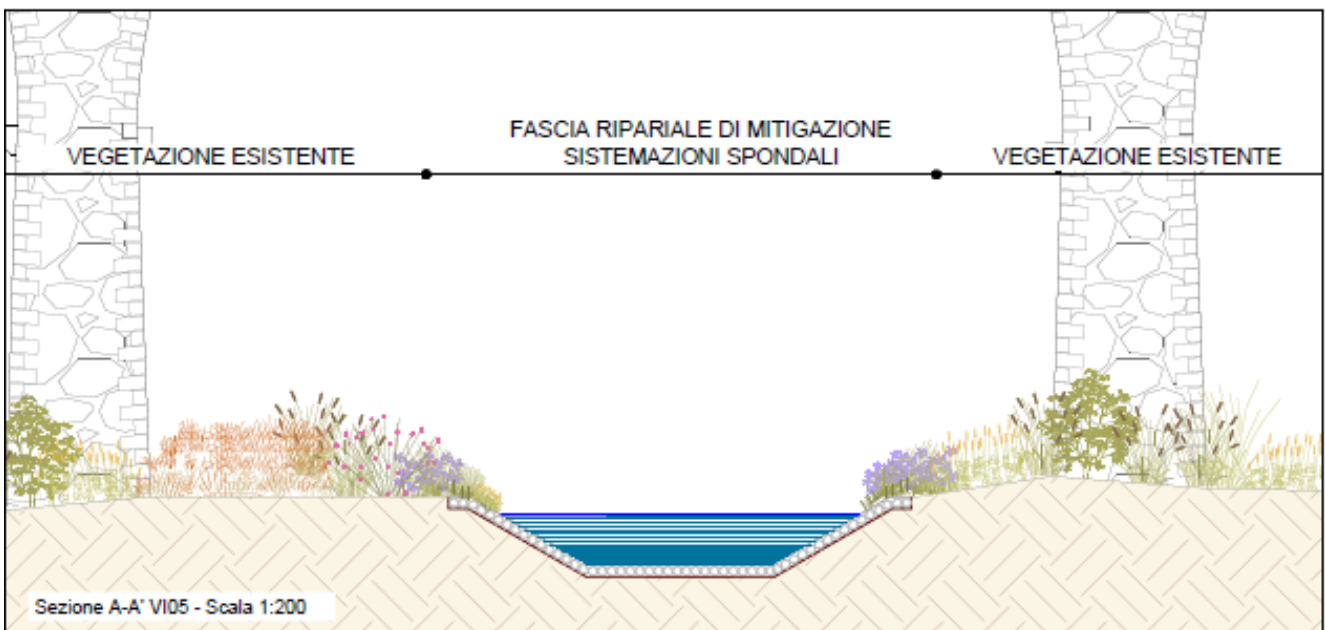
Stralcio Elaborato "Planimetrie degli interventi di mitigazione e compensazione" (RS6K02D22P6IA0000002B)
